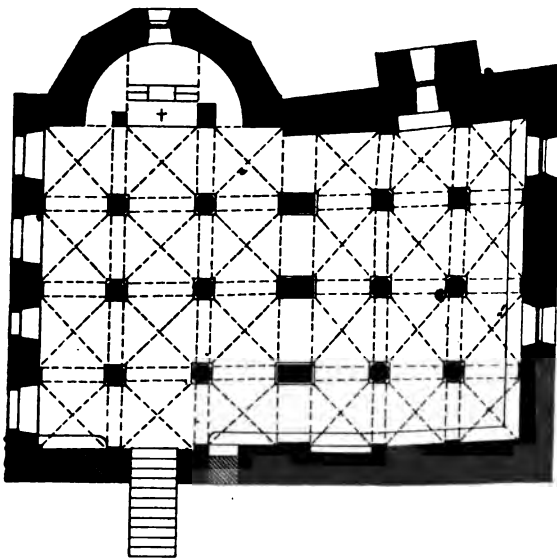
Zülrich, Kathol. Pfarrkirche. Grundriss der Krypta.
